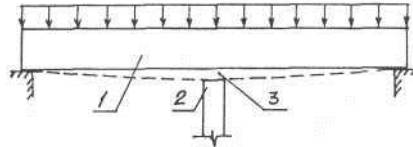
(1 — усиливаемая балка, 2 — дополнительная опора, 3 — зазор)
